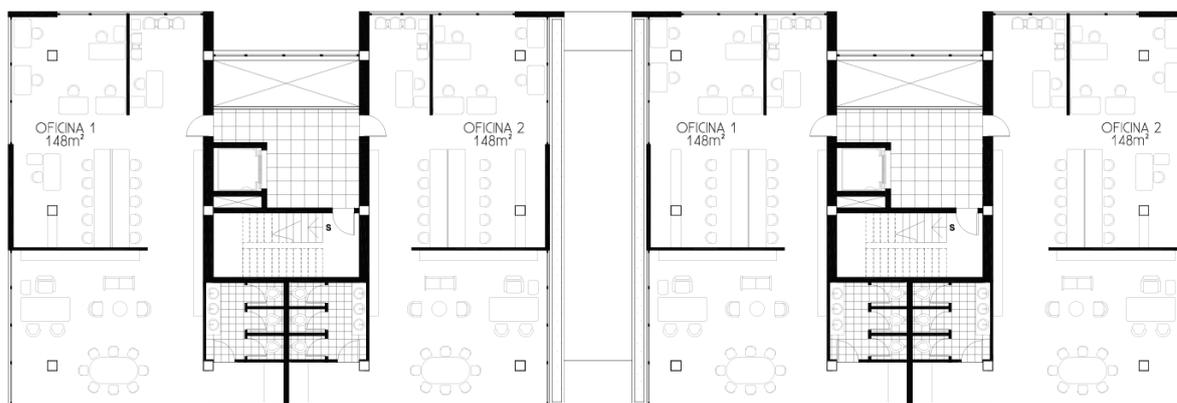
Planta tipo oficinas bloque. Elaboración propia
